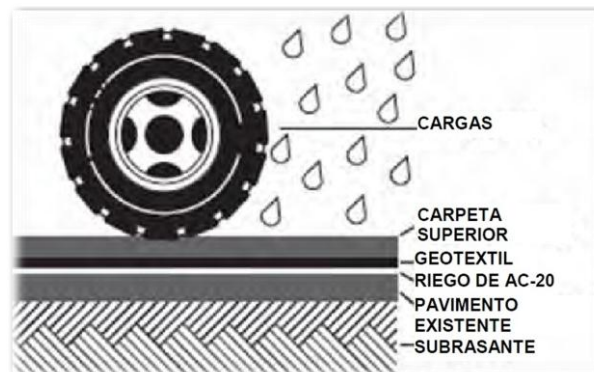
Geotextil usado en la rehabilitación de pavimentos.
